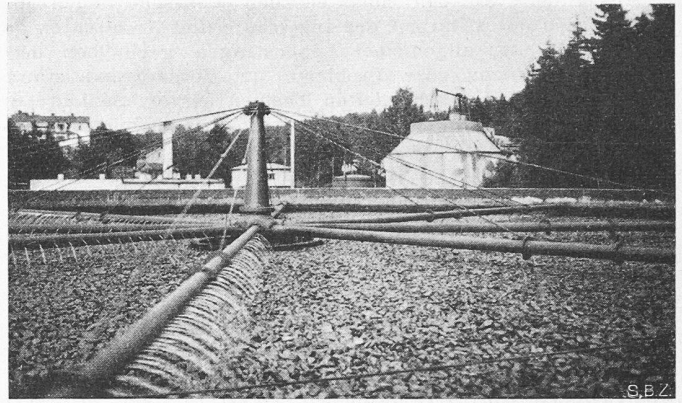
Schnellaufender achttarmiger Drehsprenger zu Bild 2
